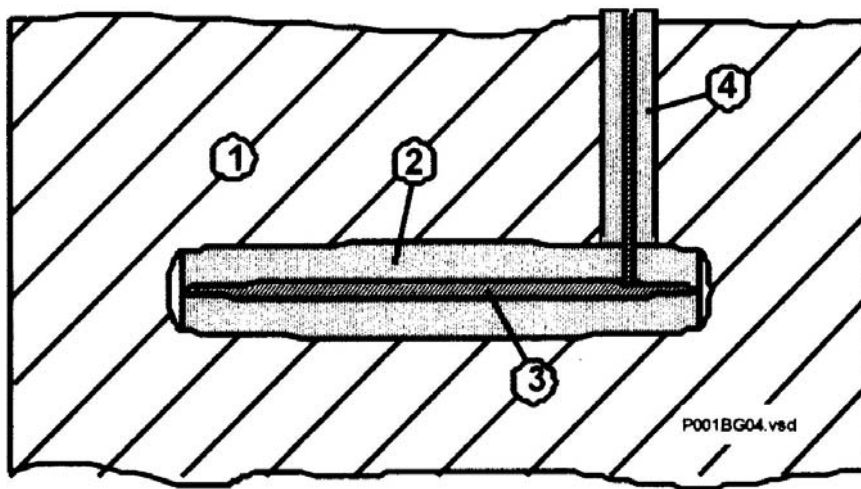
Betonspannungsgeber im Beton eingebaut.
